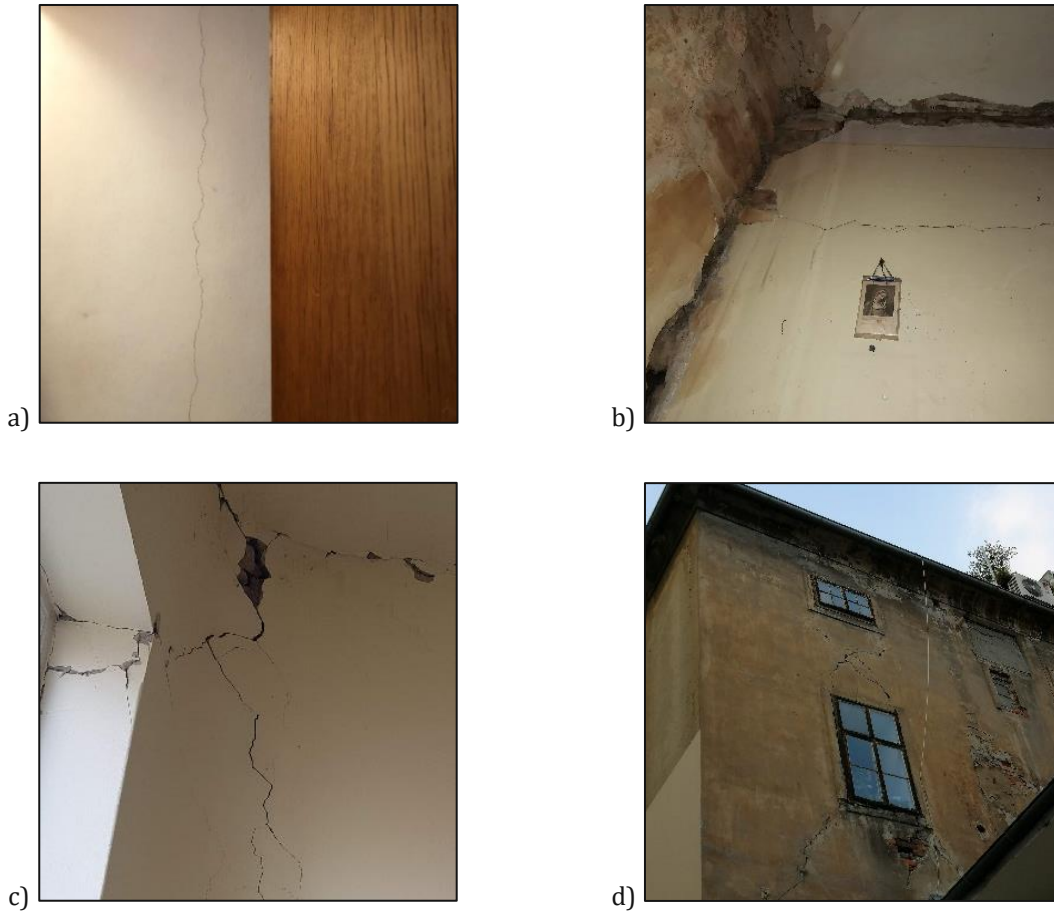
Exemplarische Schadensbilder an der tragenden Mauerwerksstruktur mit a) Objekt 11 – vertikaler Riss in der Längswand (S1); b) Objekt 35 – beschädigte Anschlussbereiche (S4); c) Objekt 9 - beschädigte Anschlussbereiche (S3) und d) Objekt 29 – kreuzförmige Risse an Sturz und Parapet (S4). *Fotos: Mario Todorčić.
